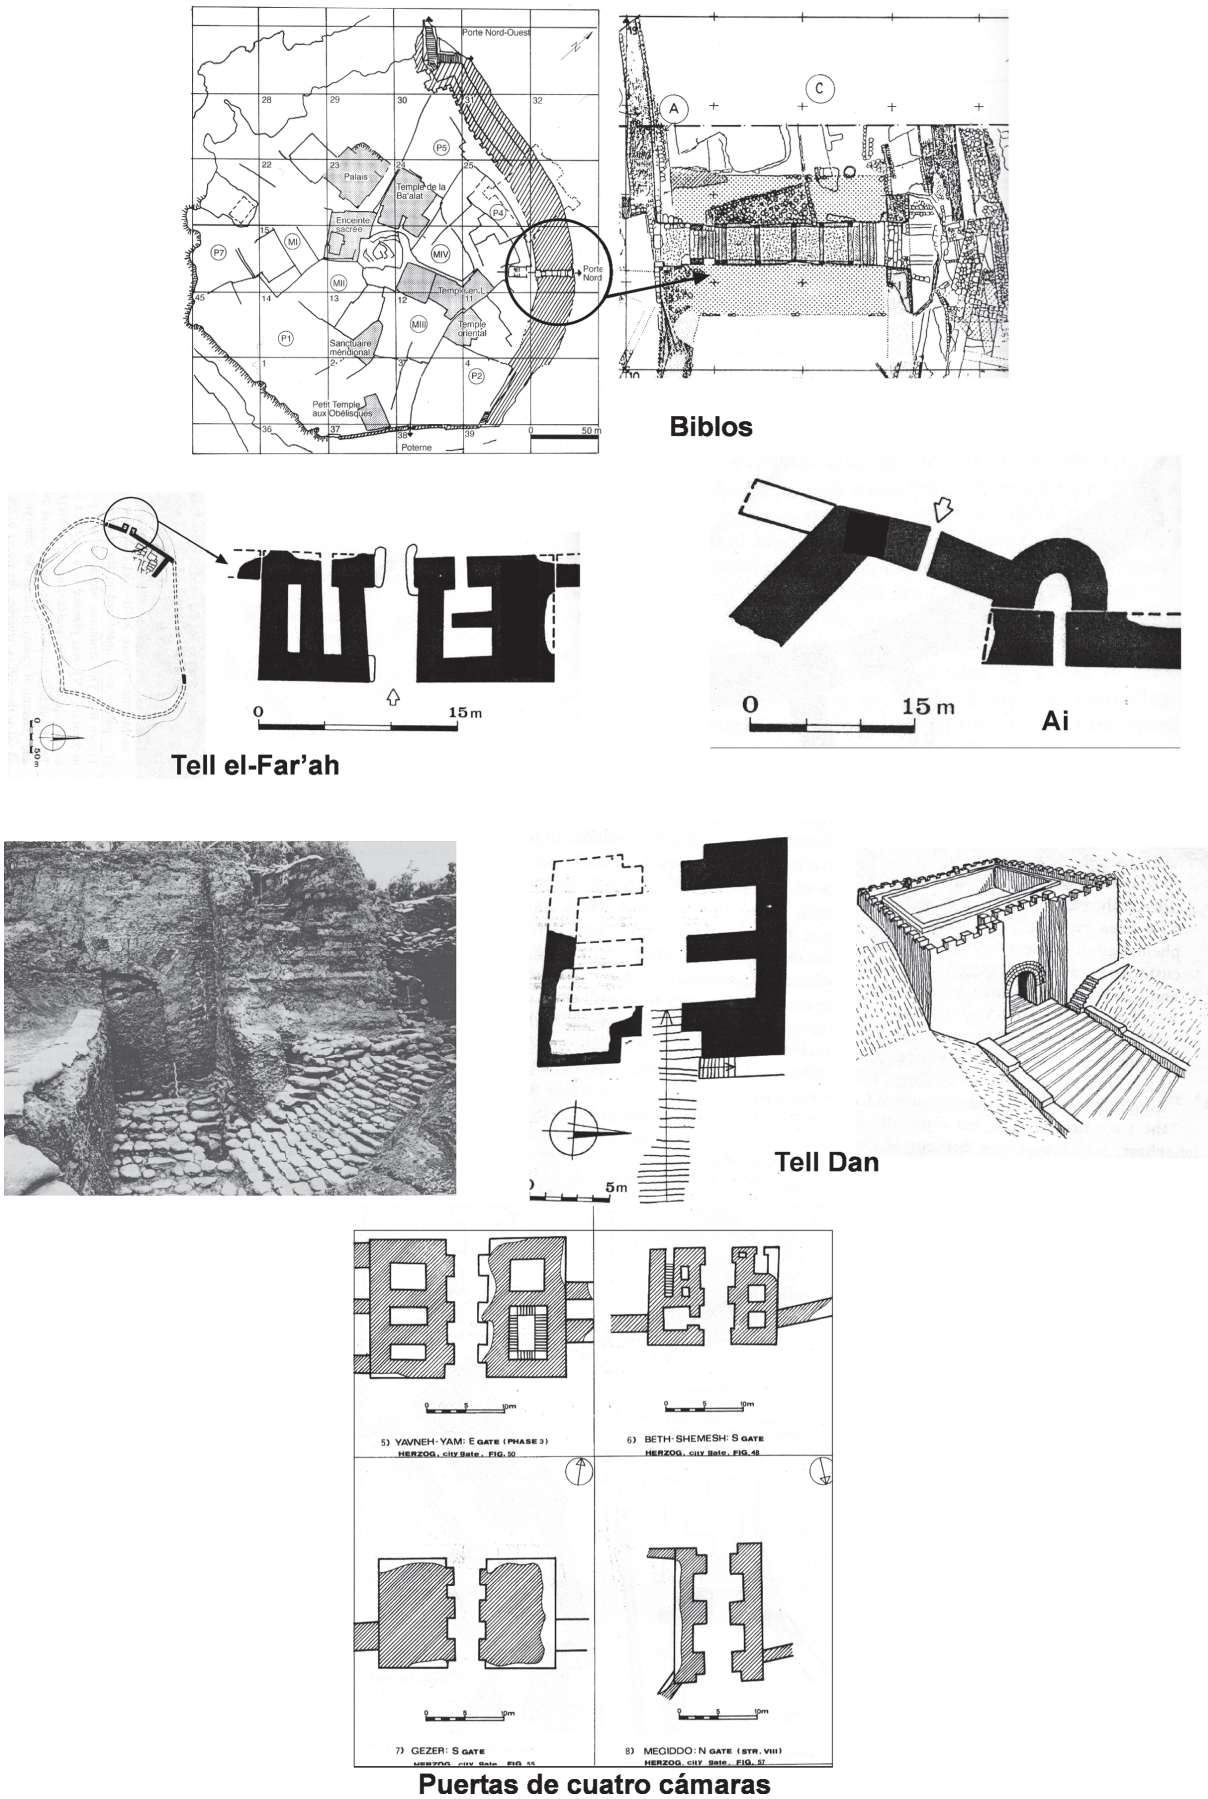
Biblos: Planta general de la ciudad y de la puerta norte (Lauffray 2008). Tell el-Far'ah: Planta general del asentamiento y de la puerta de acceso (Kempinski 1992a). Ai: Planta de la poterna flanqueada por la torre semicircular (Kempinski 1992a). Tell Dan: Vista general de la puerta de la Edad del Bronce Medio. Planta y reconstrucción de la puerta de cuatro cámaras (Kempinski 1992b). Puertas de cuatro cámaras: Plantas de las puertas de la Edad del Bronce de las ciudades de Yavneh-Yam, Beth-Shemesh, Gezer y Megido (Gregori 1986).
